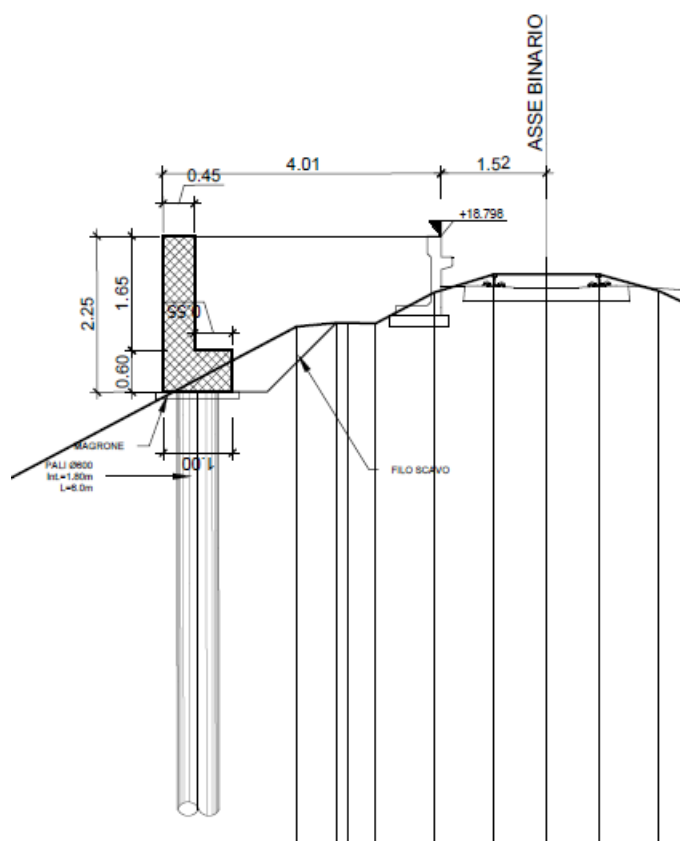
Muro di sostegno su pali – Sezione tipo .
